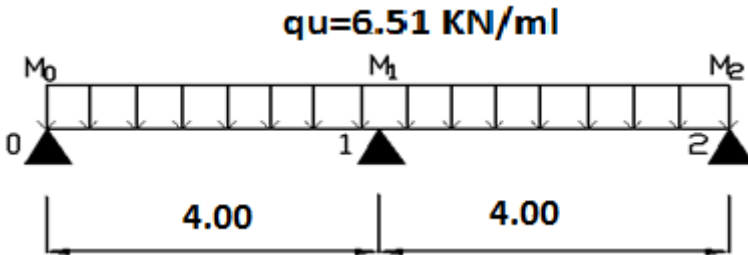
schéma statique de la poutrelle type 1 à l'ELU
